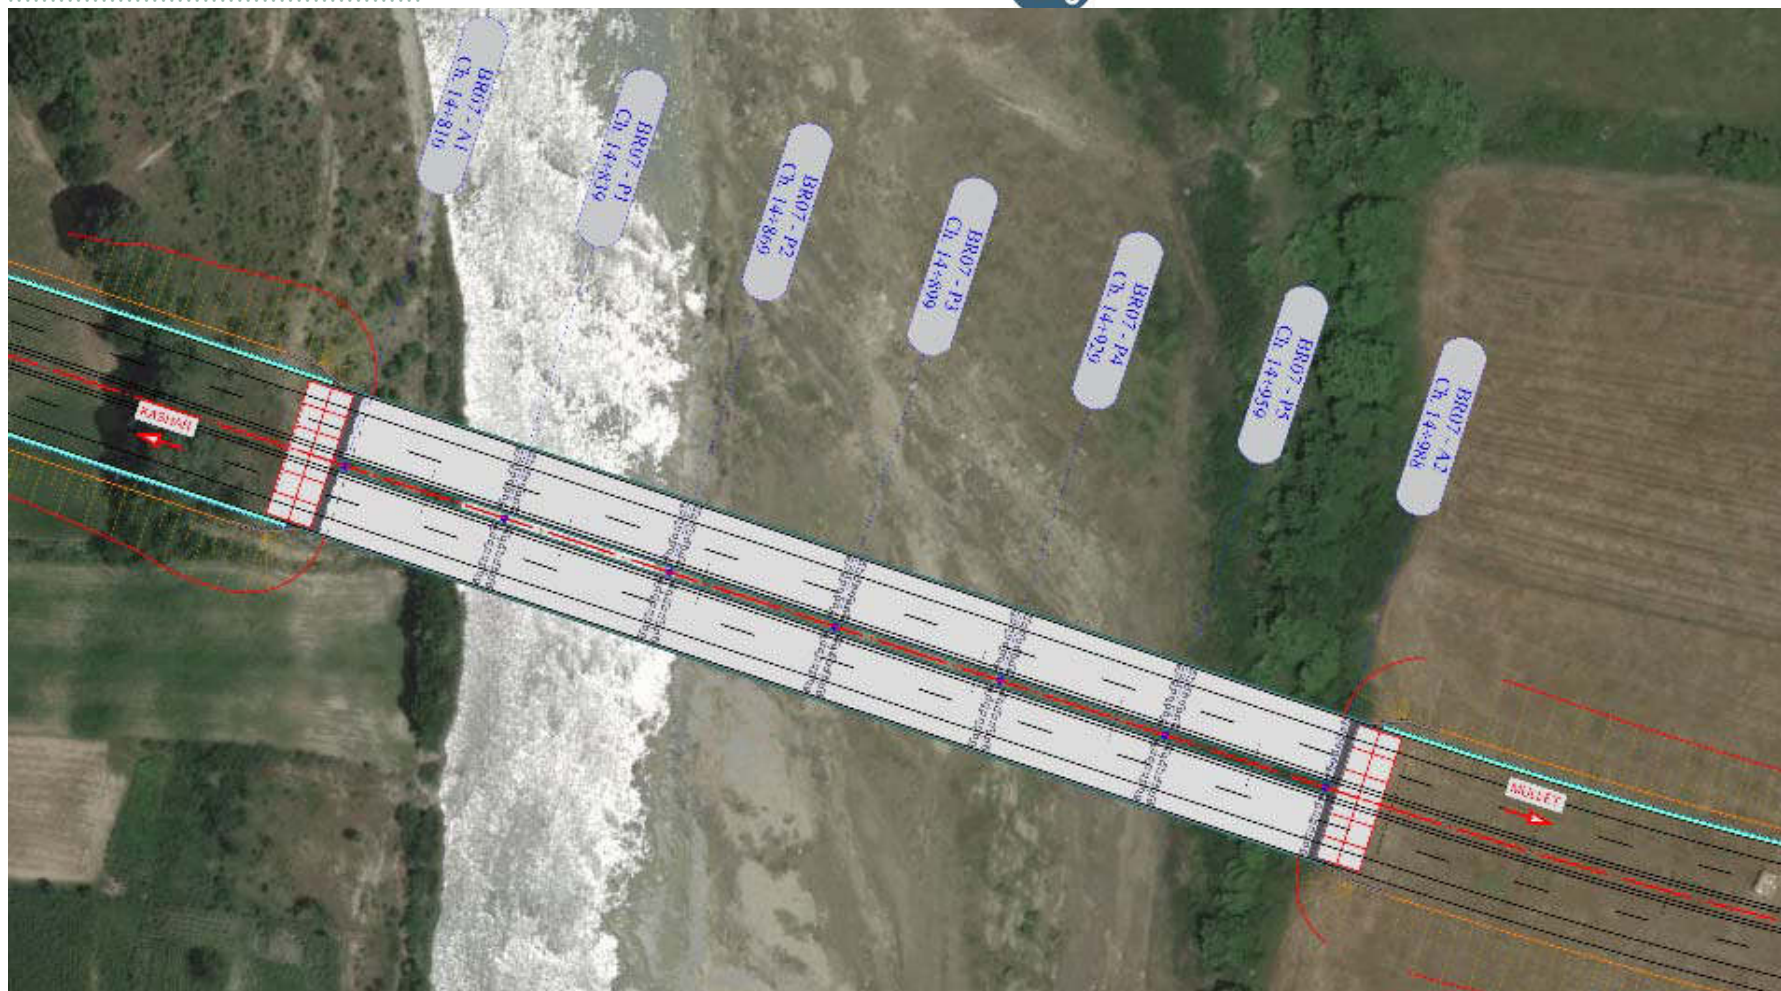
Pamje planimetrike e Urës 07, L=180m (Hapësira 6x30m)
